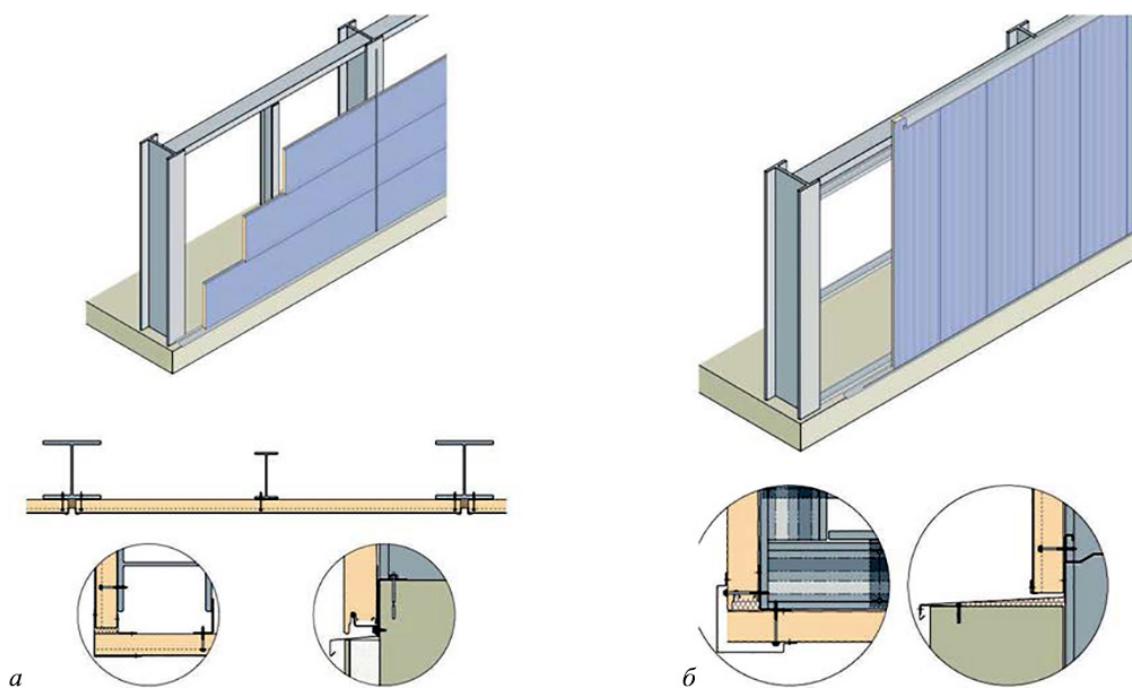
Схема разрезки зданий: *а* – горизонтальная; *б* – вертикальная
